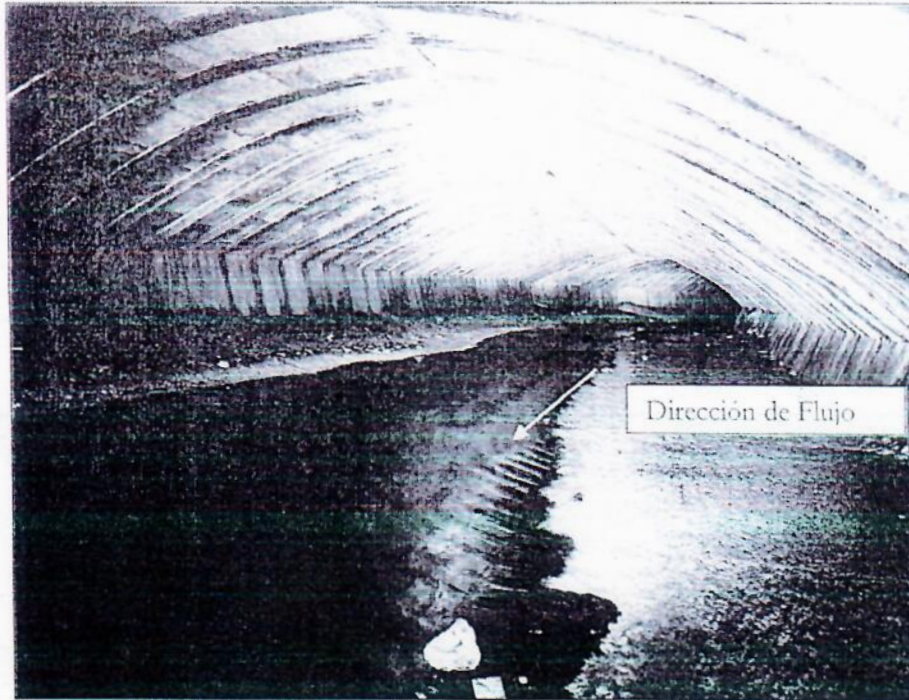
Descarga de estructuras hacia tramo de quebrada a cielo abierto.
